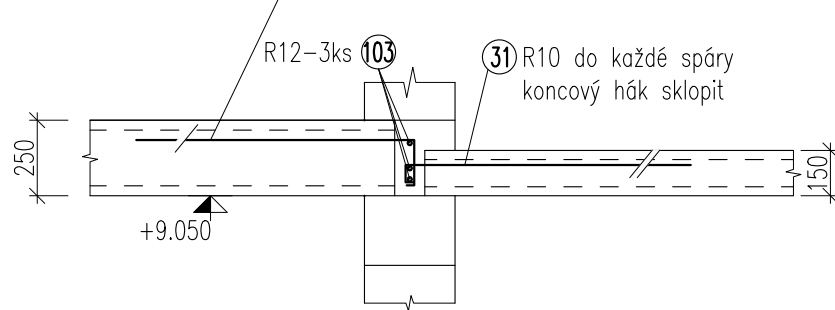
DETAIL PROVÁZÁNÍ KOLMÝCH VĚNCŮ A PRŮVLAKŮ
